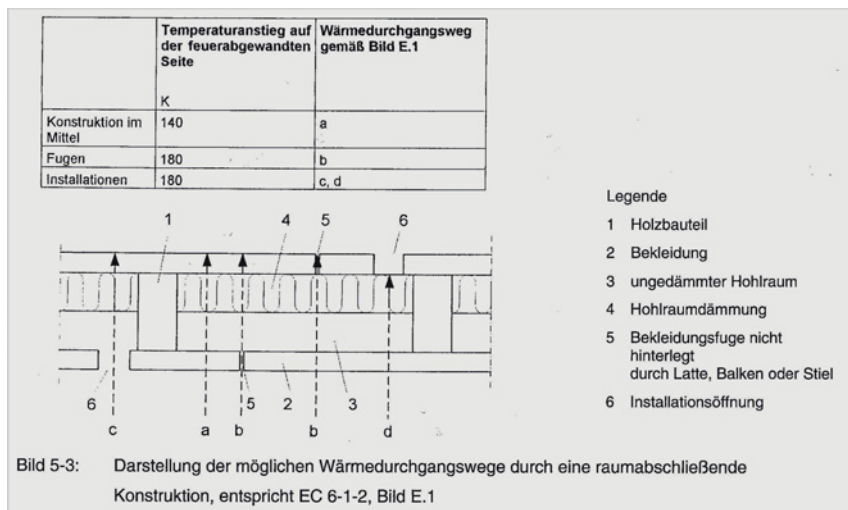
Holzbau unter Brandeinwirkung, Nachweis Raumabschluss
